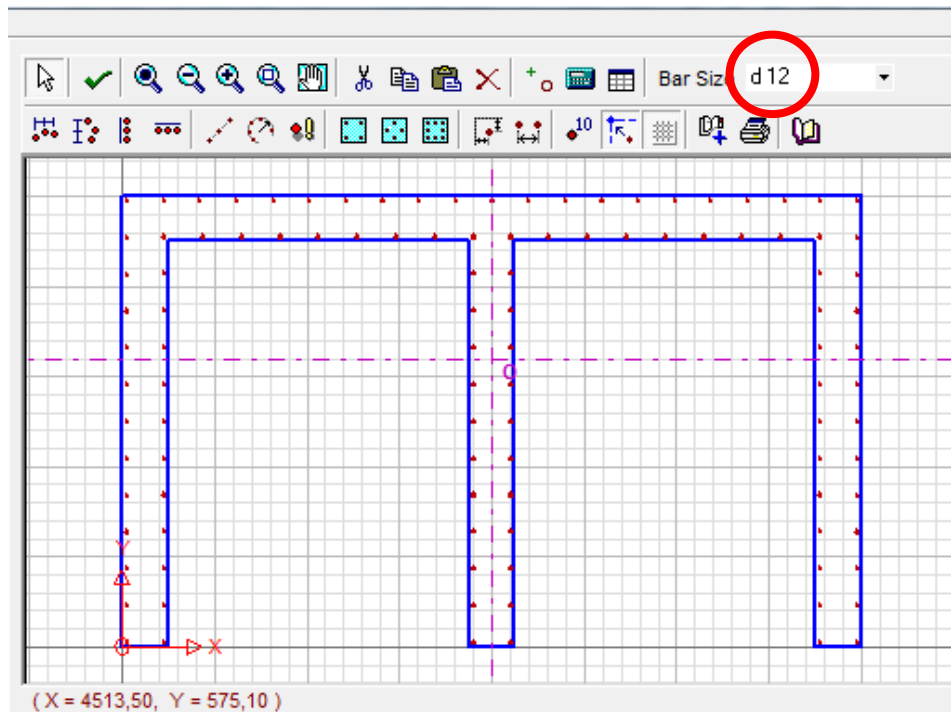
Section de la cage avec un choix de ferrailage initiale
